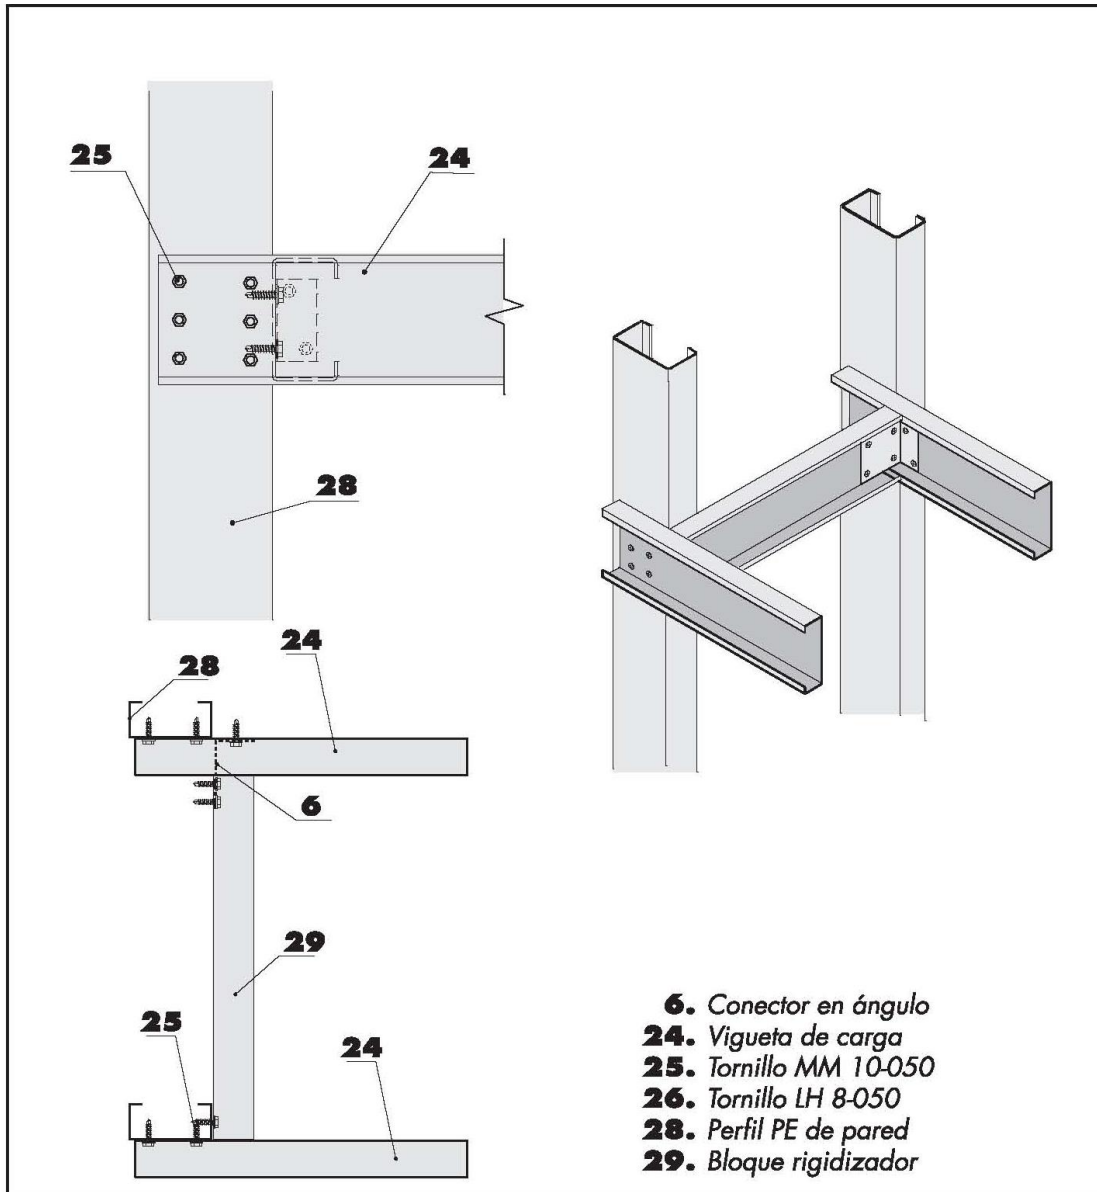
Detalle 2. Forjado. Encuentro entre perfiles de carga y verticales de pared portante [87].
